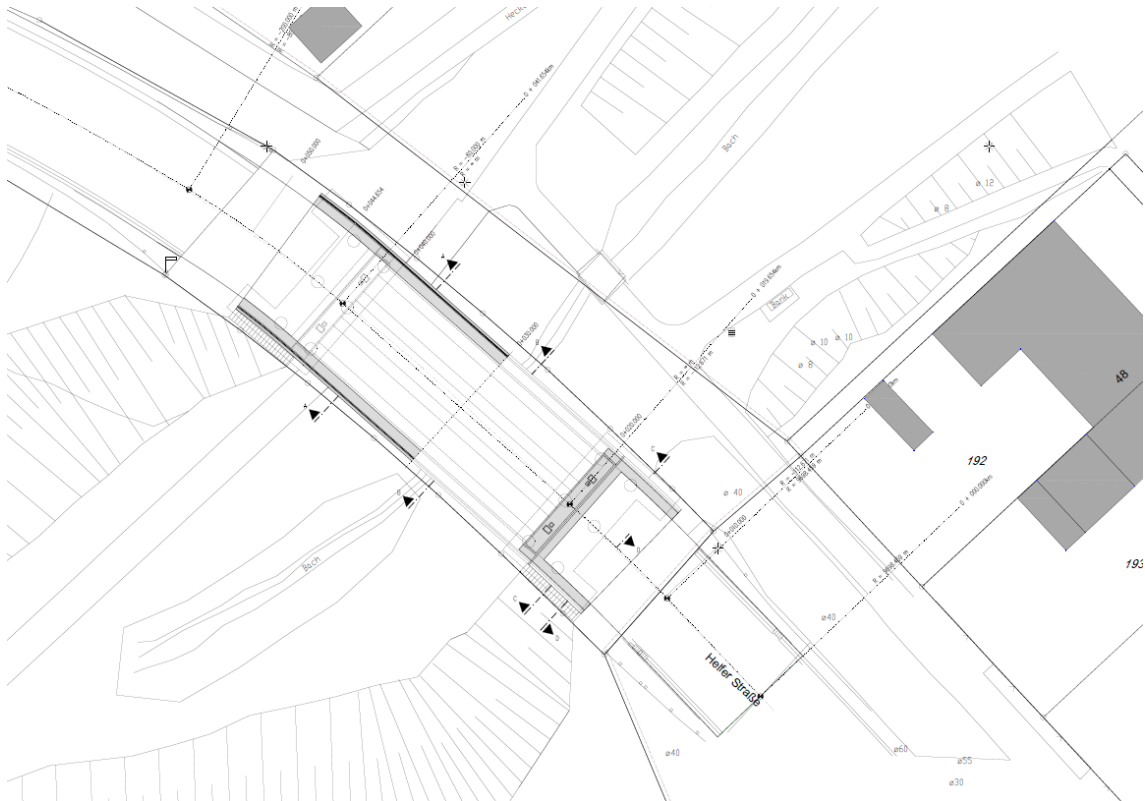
Planung Ersatzneubau der TB Helfe, Stand: 24.03.2026 (Quelle: Wirtschaftsbetrieb Hagen WBH, Fachbereich Bau)
